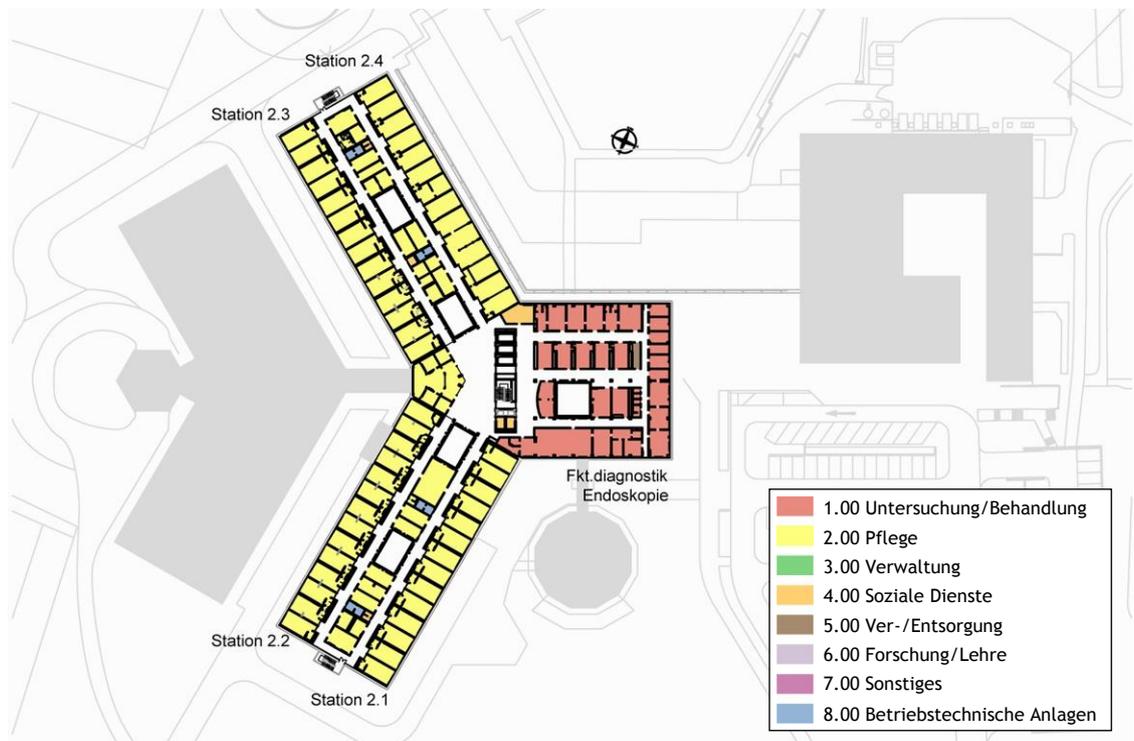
Bestandsflächen nach DIN 13080 - 2.Obergeschoss
